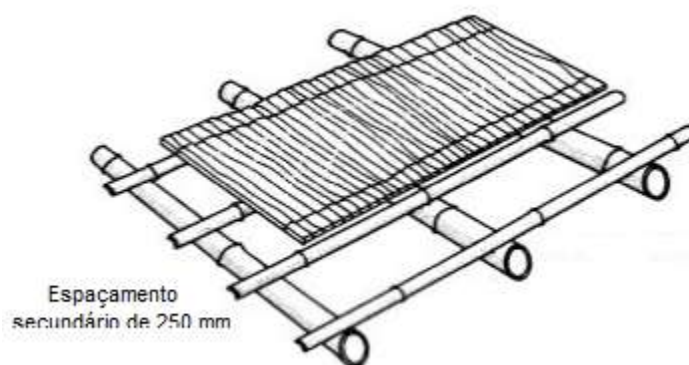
Esquema de uma estrutura de pavimento de bambu nº2 [10]
